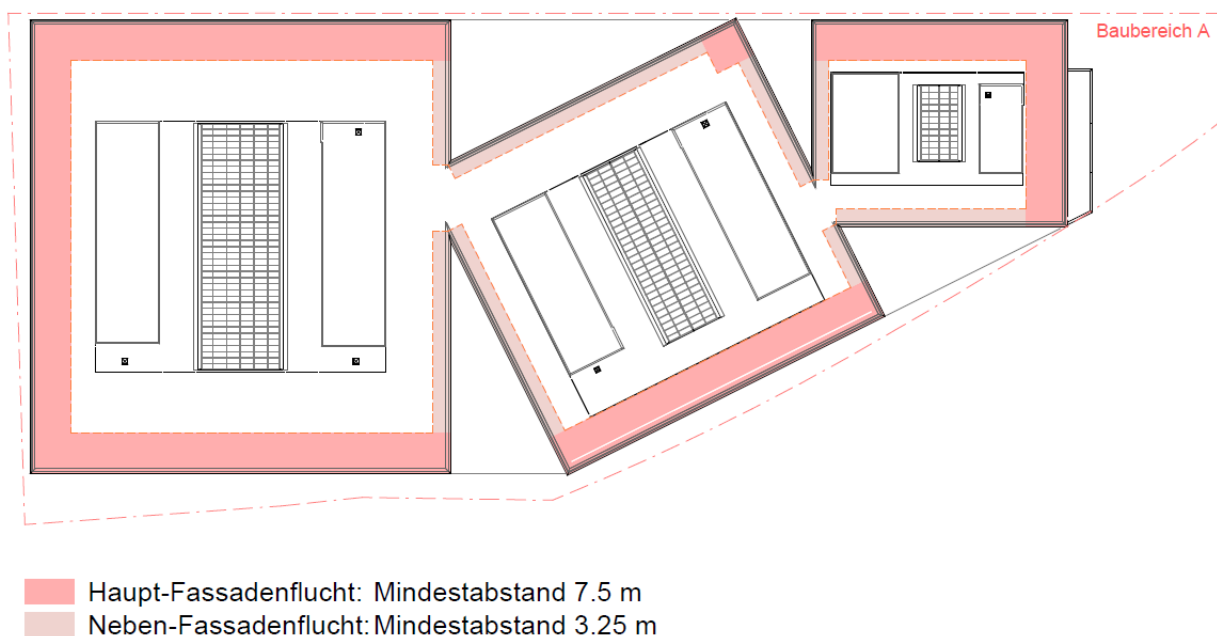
Erläuterung der Hauptfassade und Nebenfassade (Wulf Architekten 2023)
